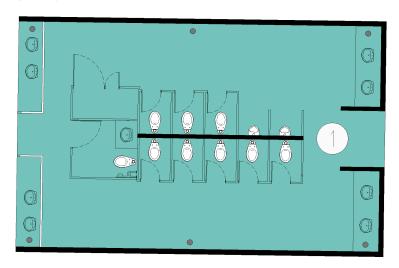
Planta Primer Nivel Fuente: Equipo Diagnóstico
